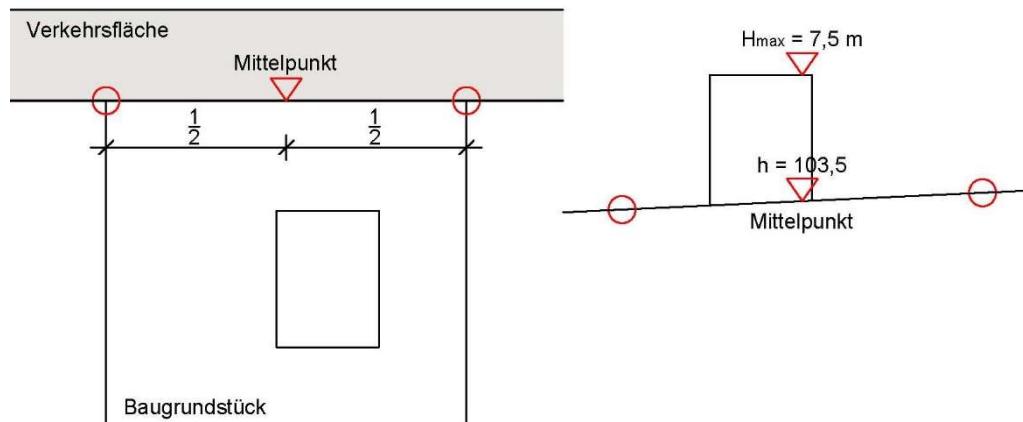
Ermittlung des Bezugspunktes zur baulichen Höhe – exemplarische Darstellung (DNR)
